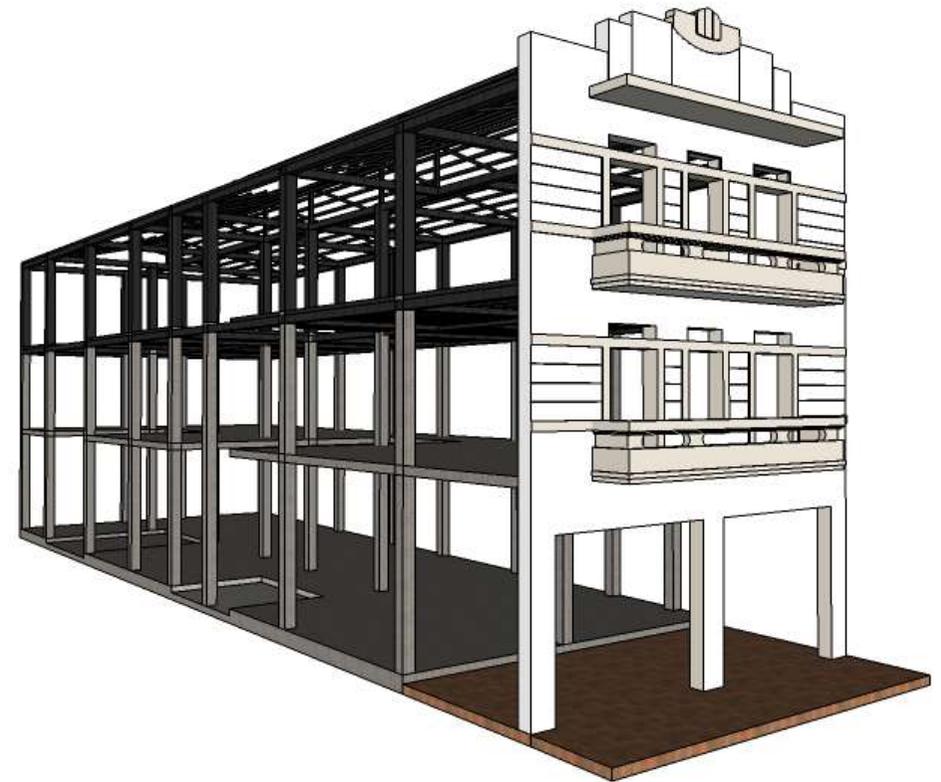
Detalle en el que se aprecia empate entre columnas de hormigón armado y encajonados metálicos
